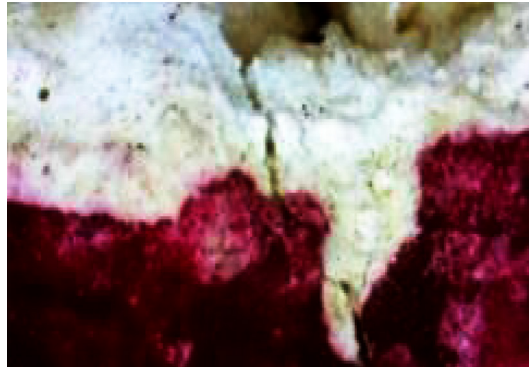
y sigs. Detalle de las probetas donde se observan las grietas y fisuras provocadas.
